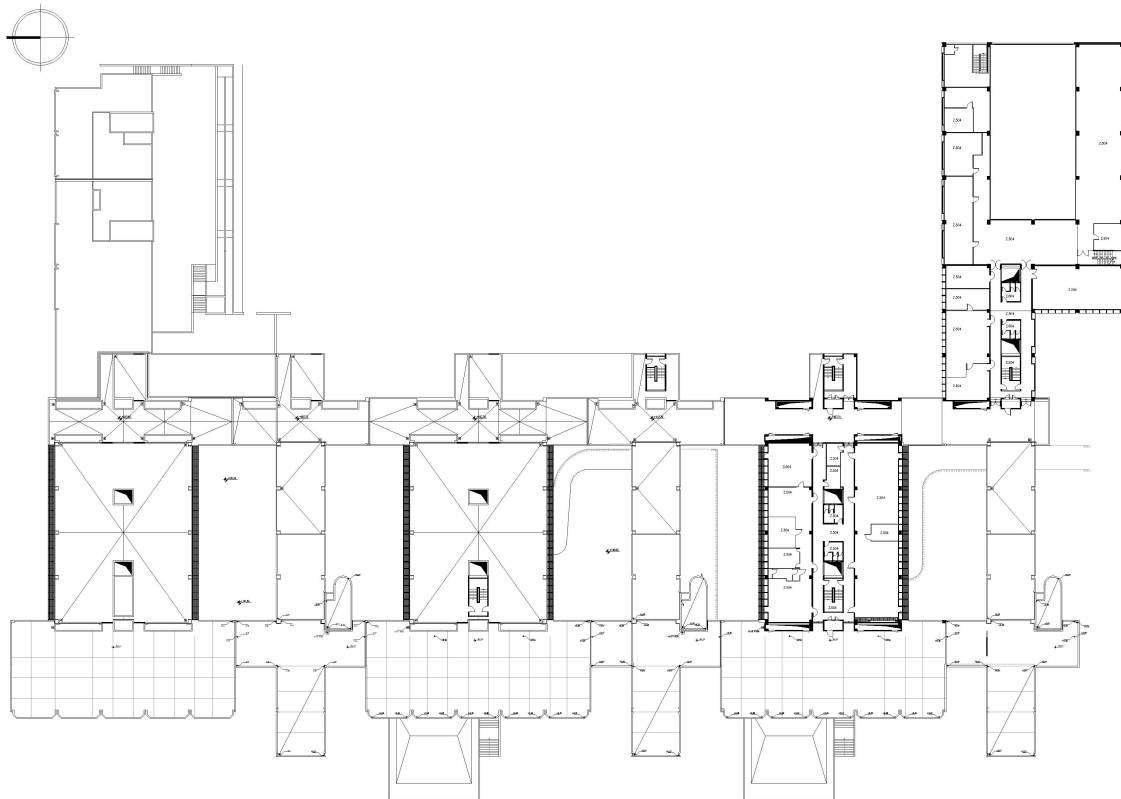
Κάτοψη πτέρυγα Θ του επιπέδου 4
